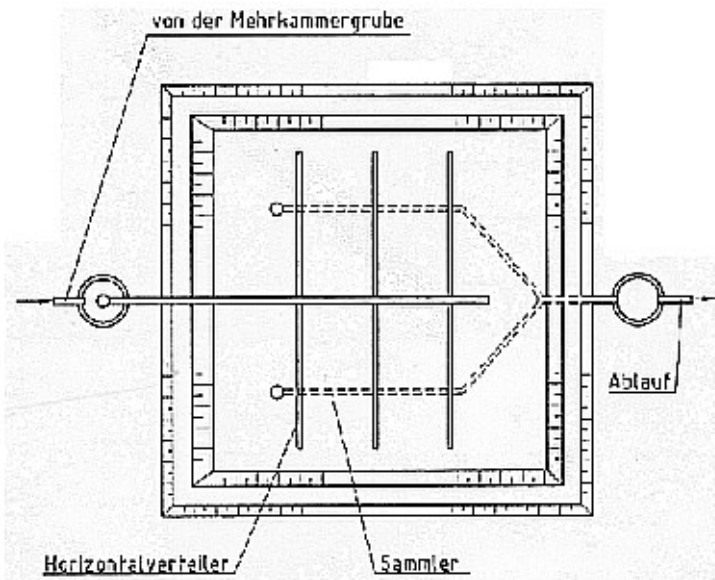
Bewachsener Bodenfilter (vertikal durchflossen)
